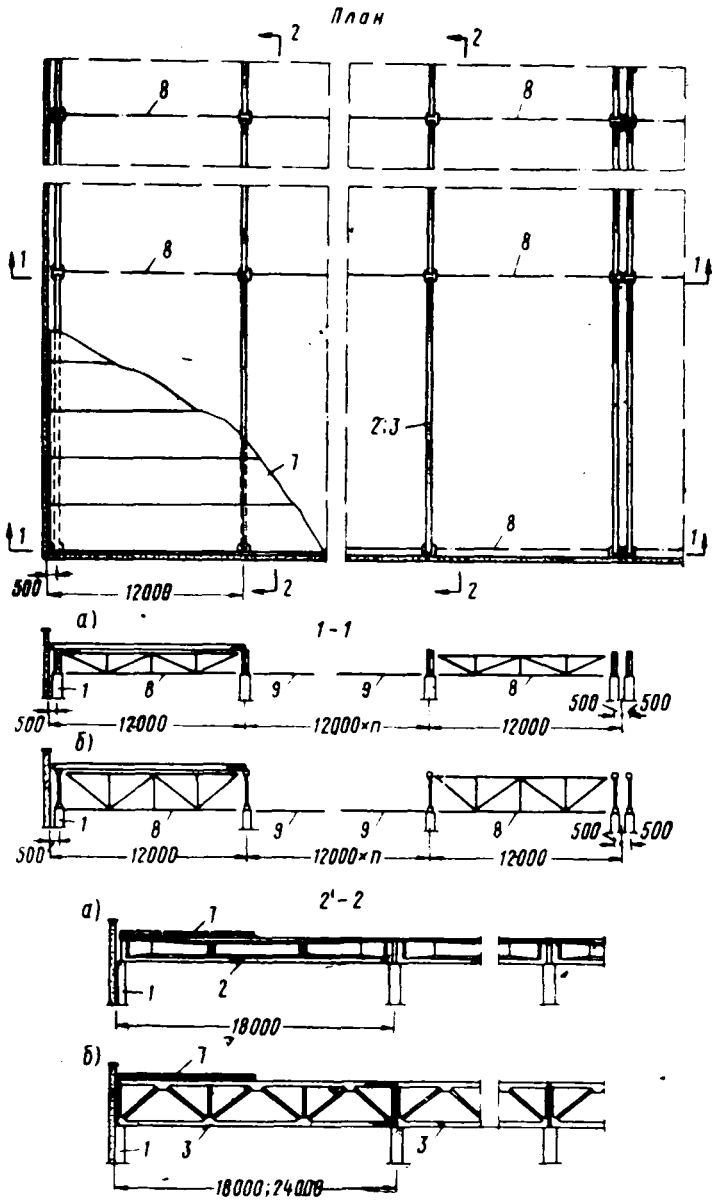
Конструктивная схема II (обозначения см. по рис. 2.5)
